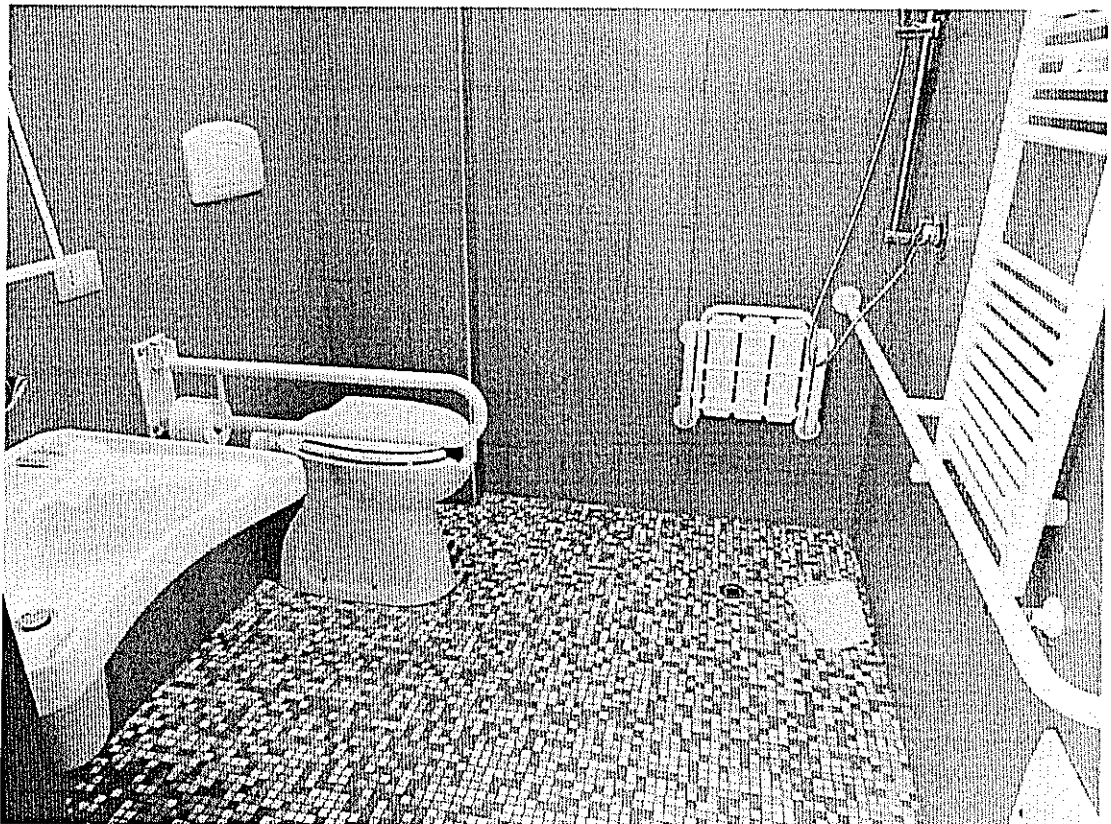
Wc della camera tipo a 2 posti letto del primo corpo di fabbrica – piano primo.
